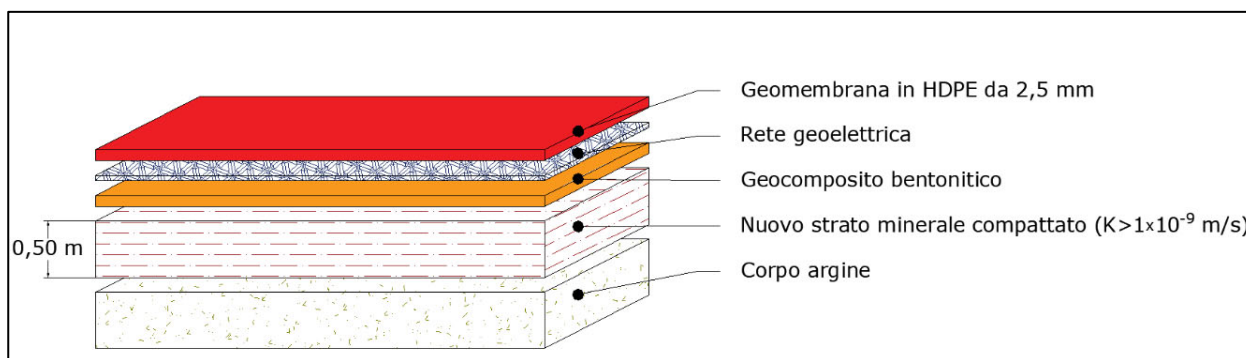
/VII: Particolare pacchetto impermeabilizzazione fondo in prossimità dell'argine
